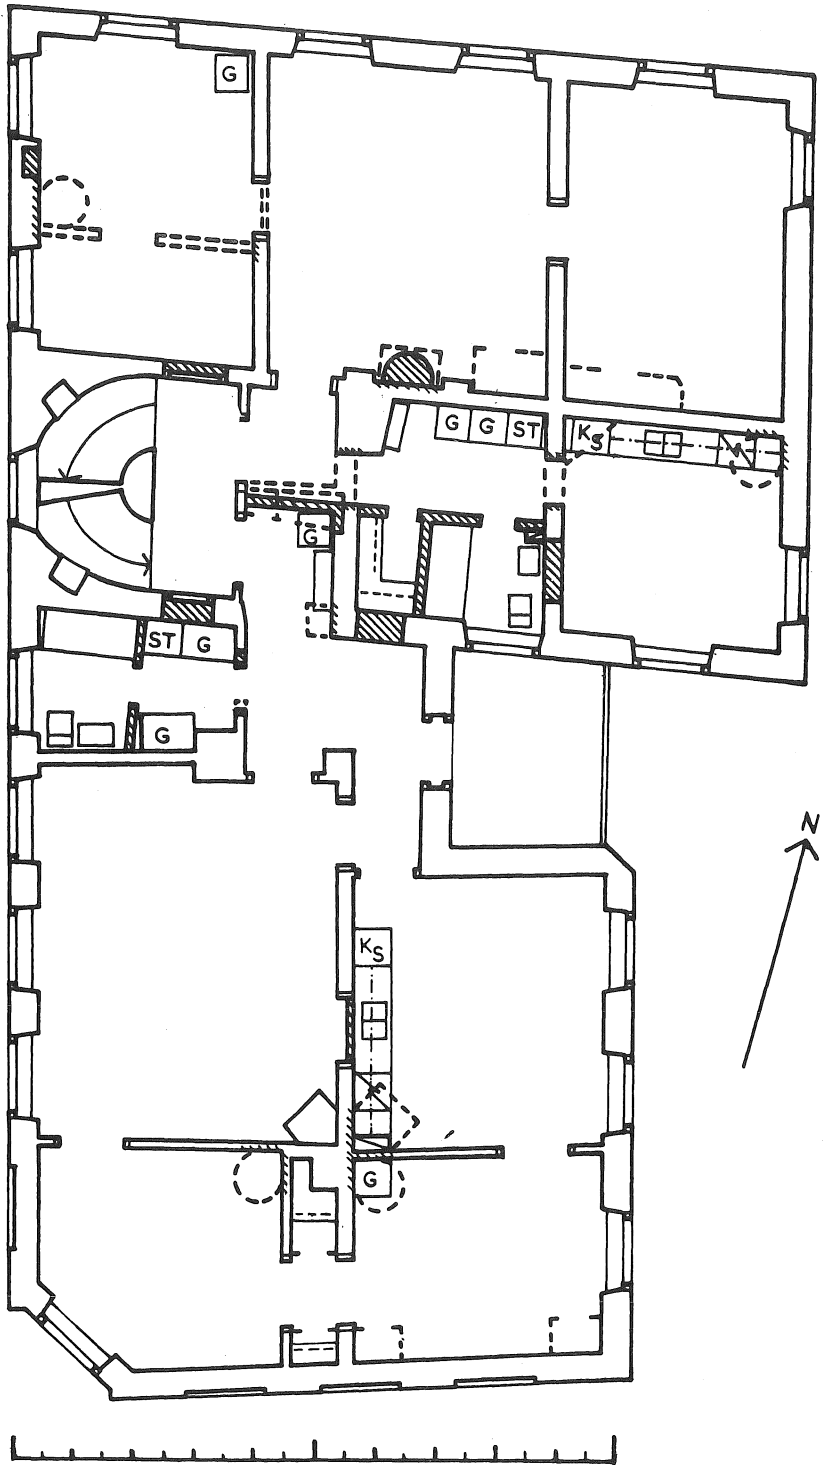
Kv Trappan nr 1 Ombyggnad av typiskt våningsplan
